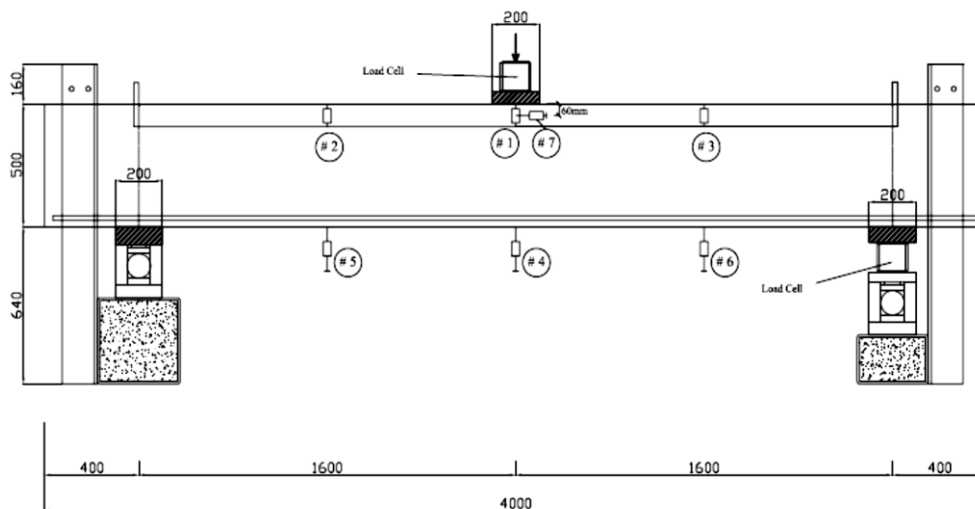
Sistema de ensaio das vigas (SAGASETA 2008)
